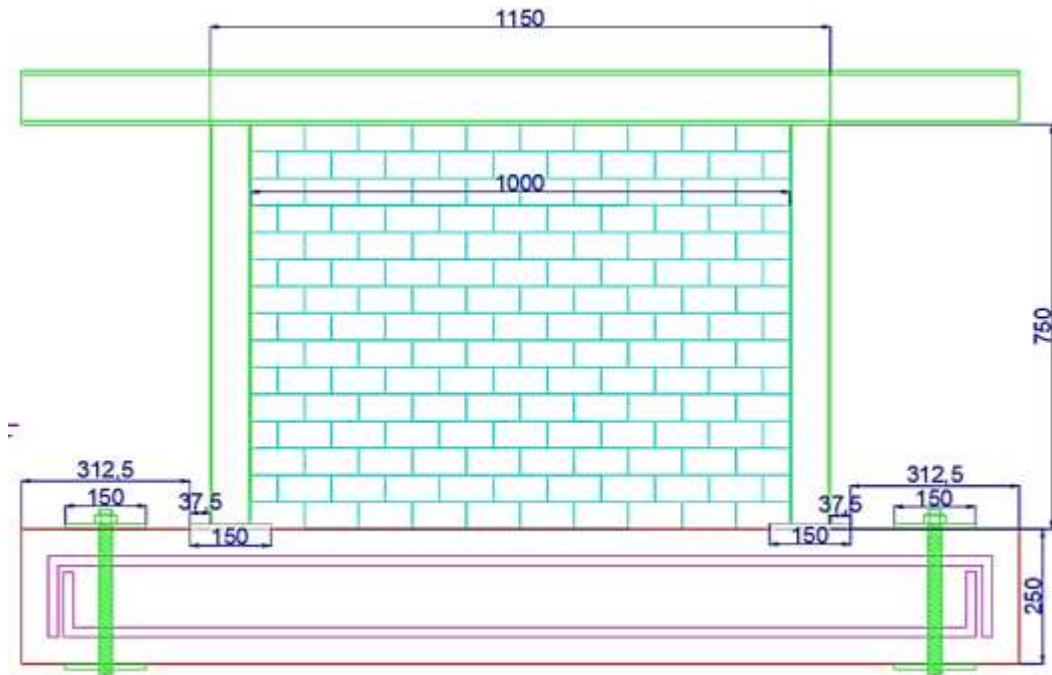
Pórtico de acero estructural de 100cm x 75cm con relleno.
